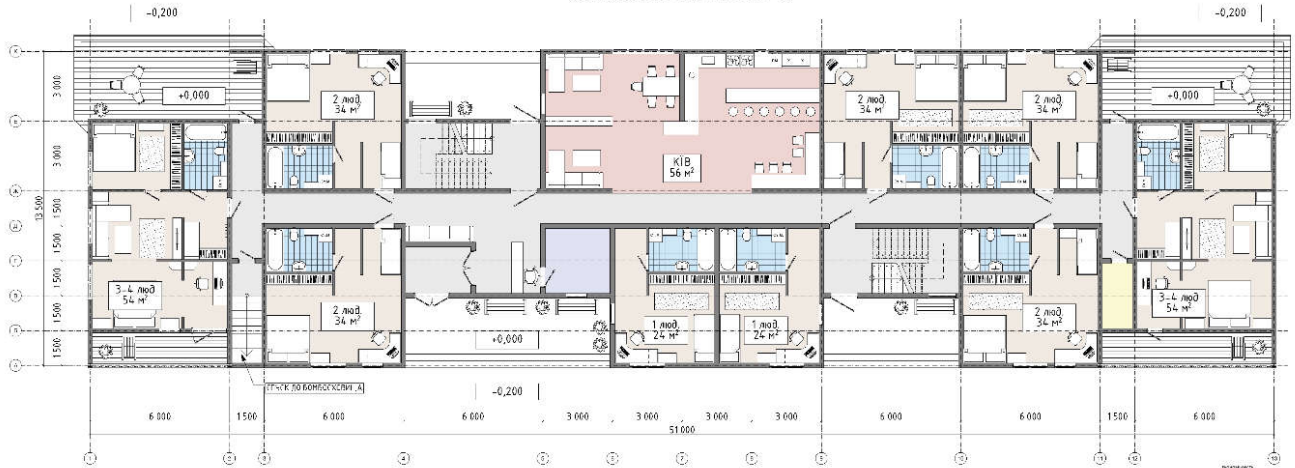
Приклад Соціального житла В-класу з плануванням
